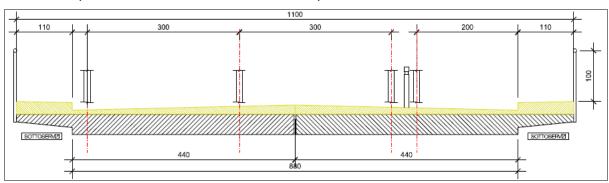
STATO ATTUALE Sezione trasversale del Ponte sulla Pesa
